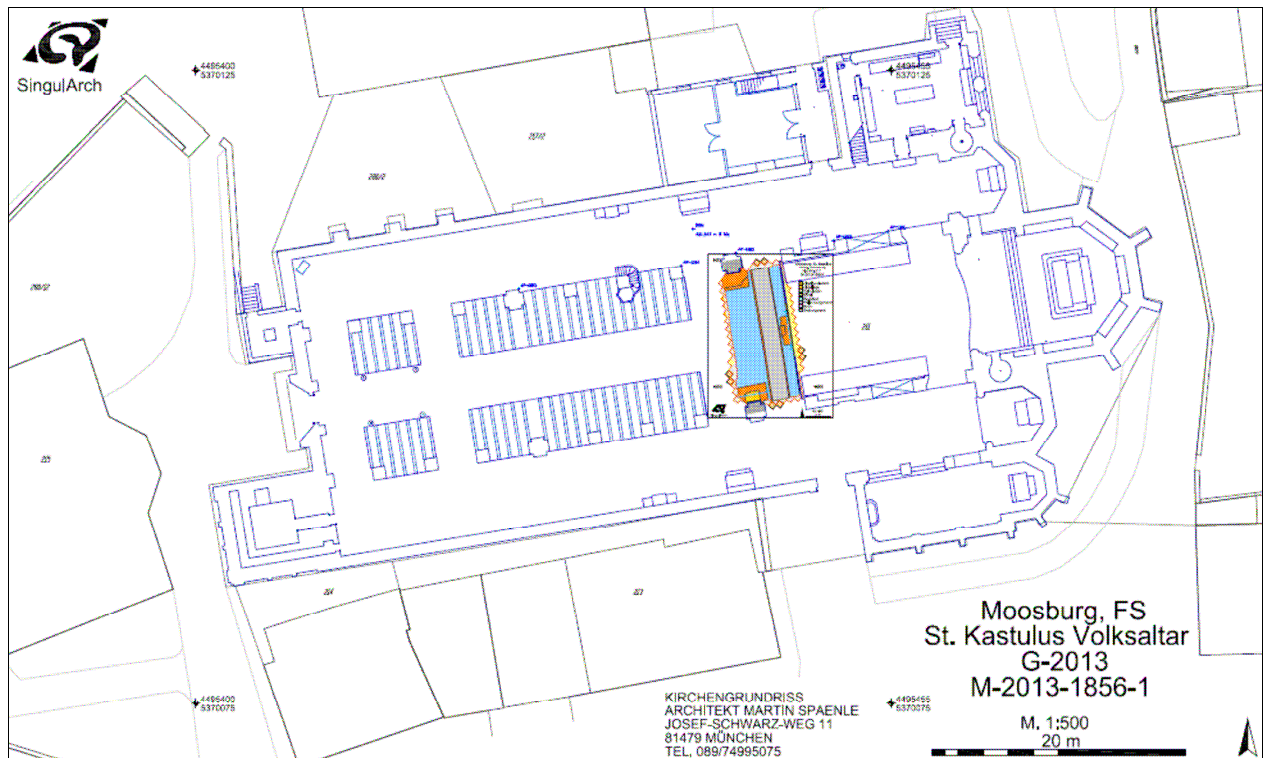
Übersichtsplan mit digitaler Flurkarte, Grundriss der Kirche und Grabungsareal (Grundriss: Architekturbüro Spaenle)
